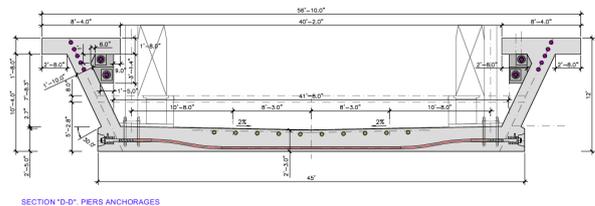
Sección transversal del puente sobre el Arroyo Poso (sección sobre pila)
